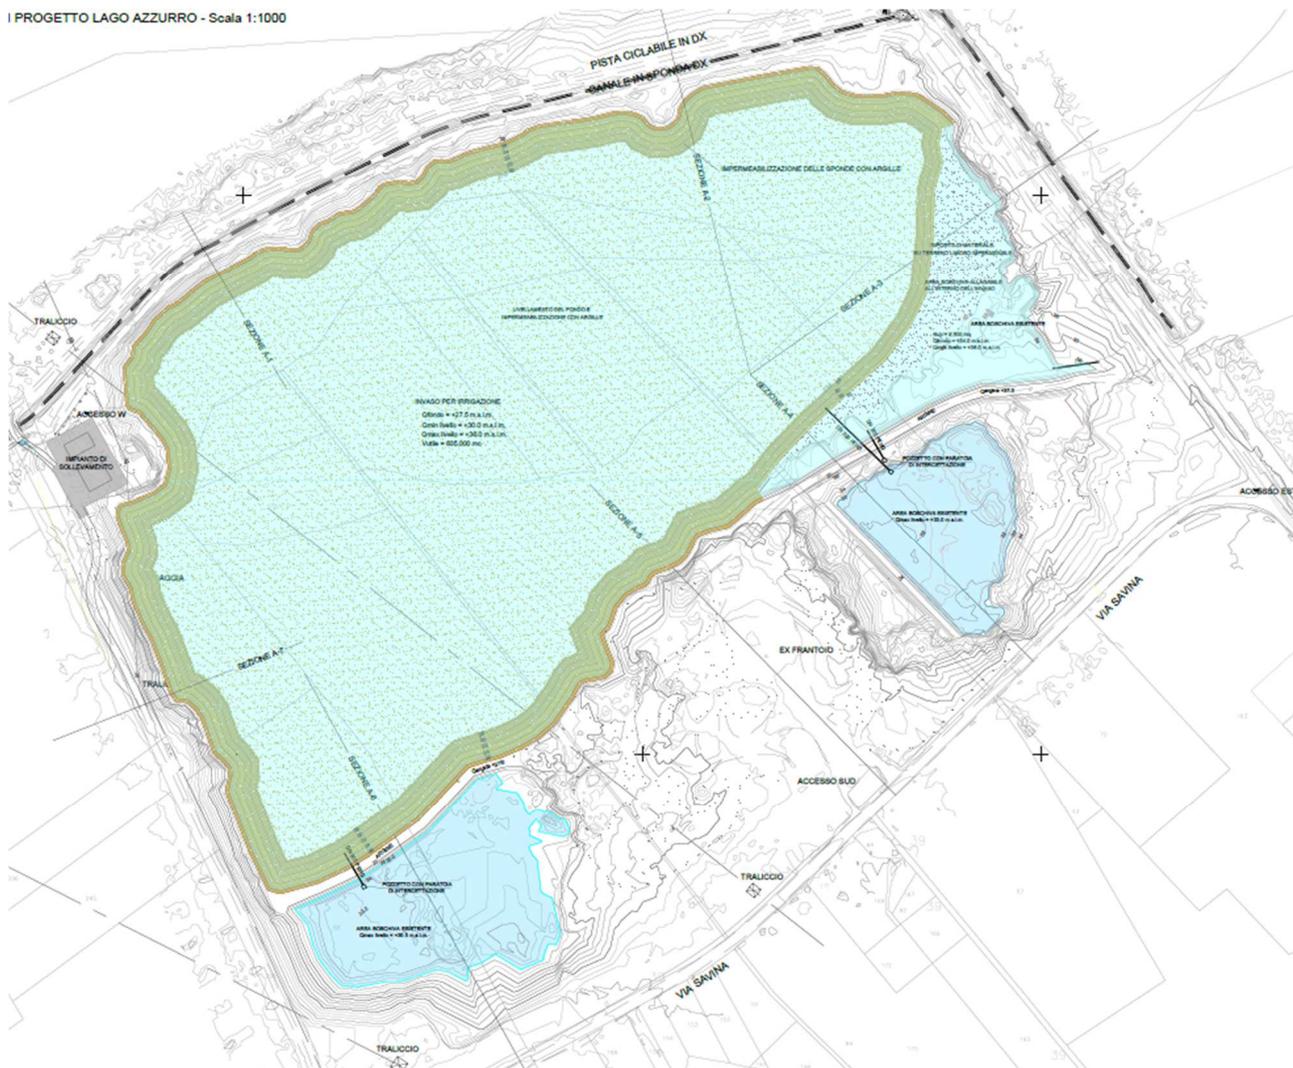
Planimetria di progetto del lago Azzurro del Progetto Definitivo
